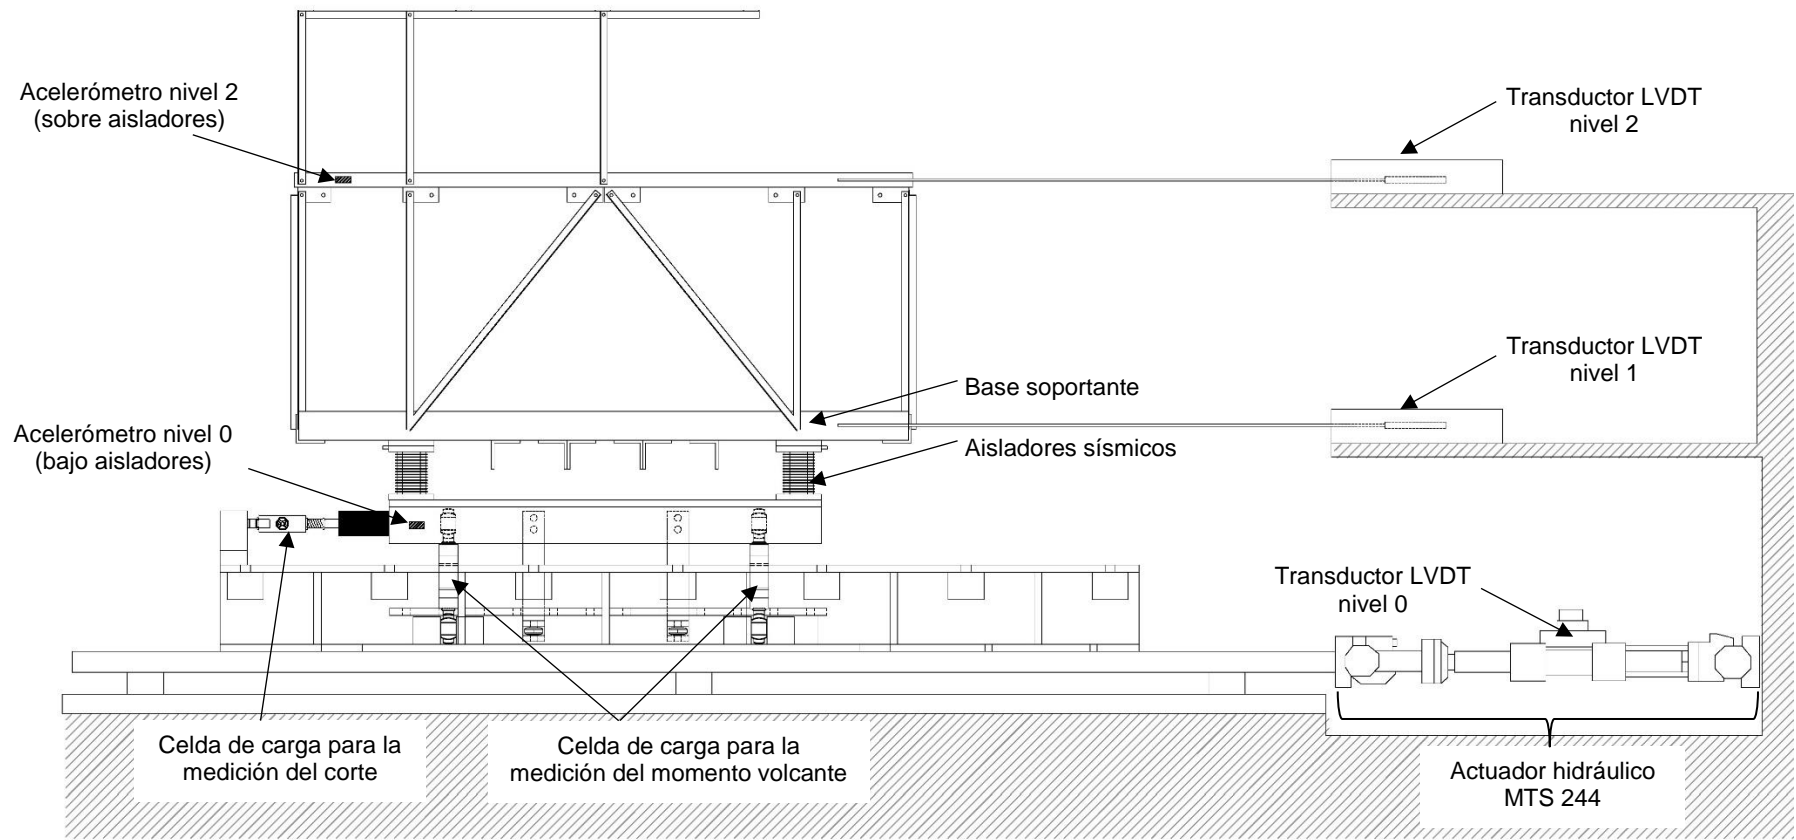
Esquema de instrumentación utilizada para el ensayo de estructuras de perfilera metálica con aislamiento sísmico.
